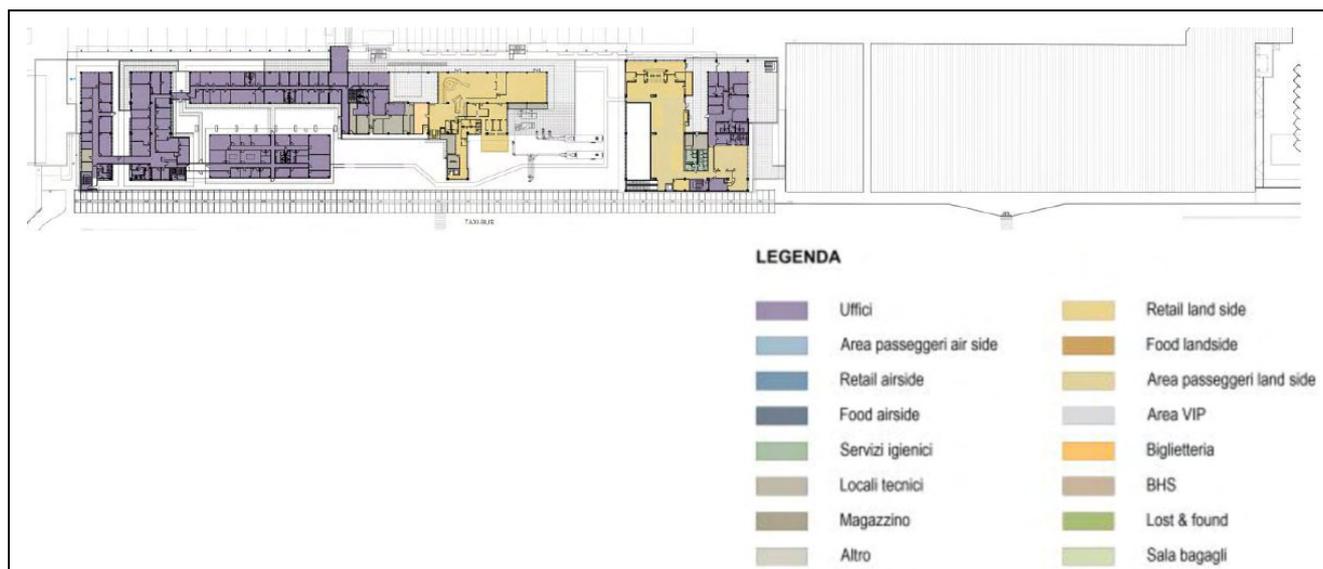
Aerostazione passeggeri – Piano Primo
